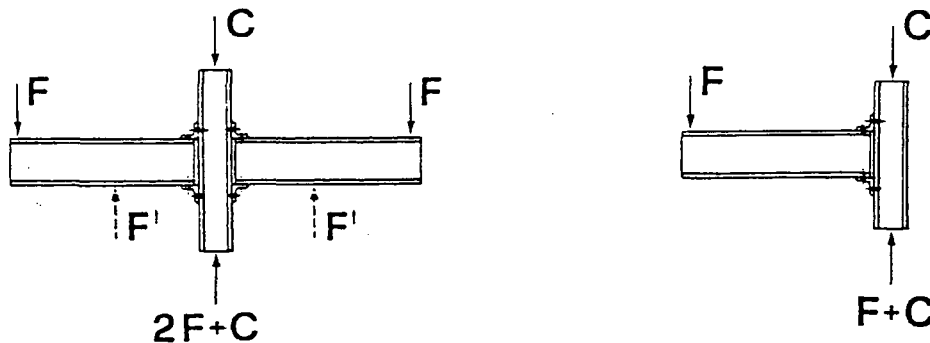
Testes com arranjos cruciforme e cantilever retirado de Kirby et al (1996).
